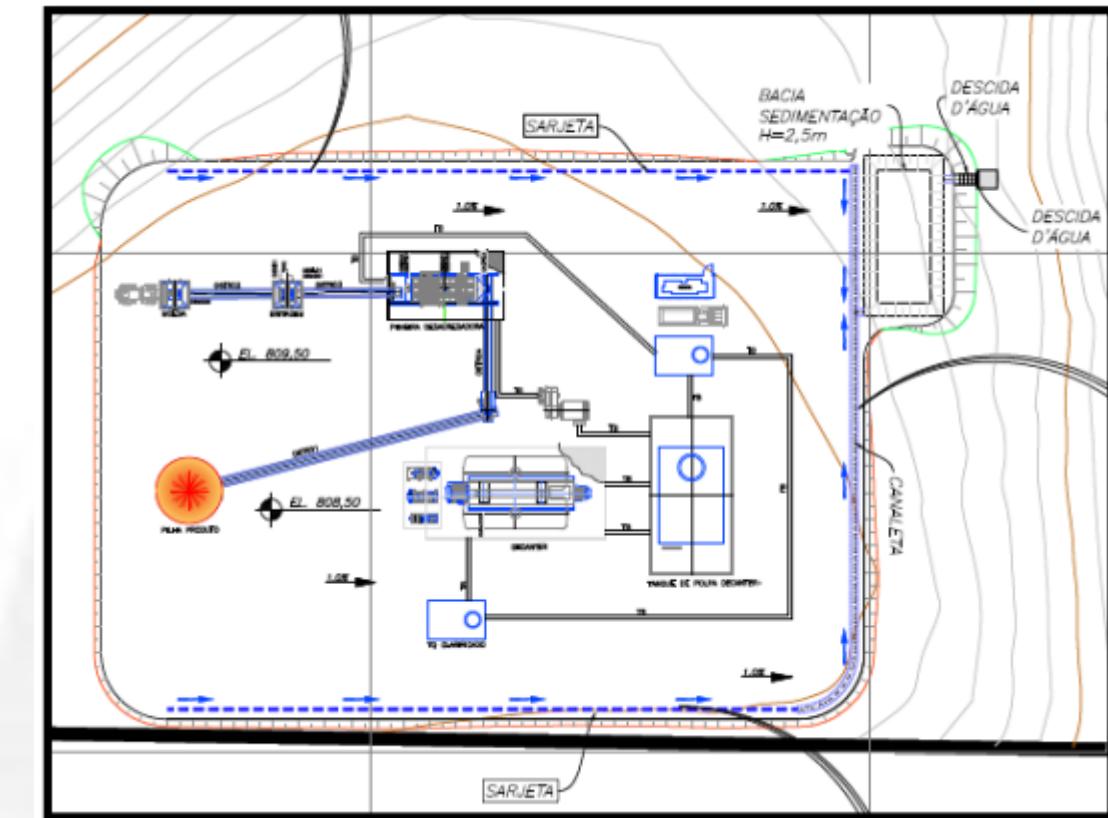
Layout da planta de Beneficiamento Móvel e Tecnosolo e o sistema de drenagem. Fonte: ICs SLA
